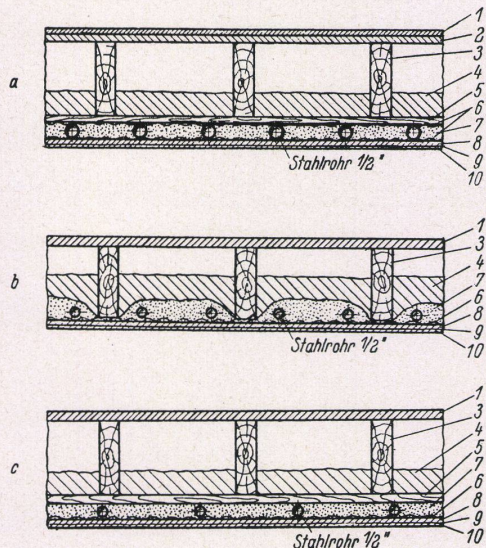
Rohrdeckenheizungen im Verputz an drei Holzbalkendecken dargestellt a Verputz mit Streckmetallgeflecht über und unter den Heizrohren, b, c mit Streckmetallgeflecht nur unter den Heizrohren
